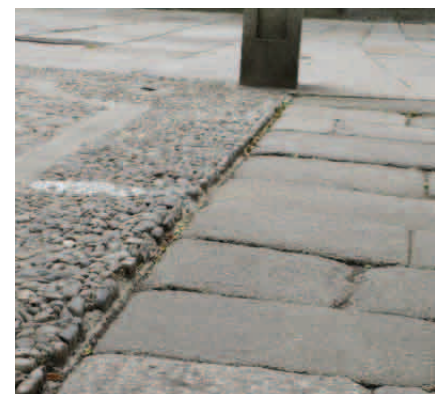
Detalle cambio pavimento y encuentro con c/Sta. María (fuente propia)
